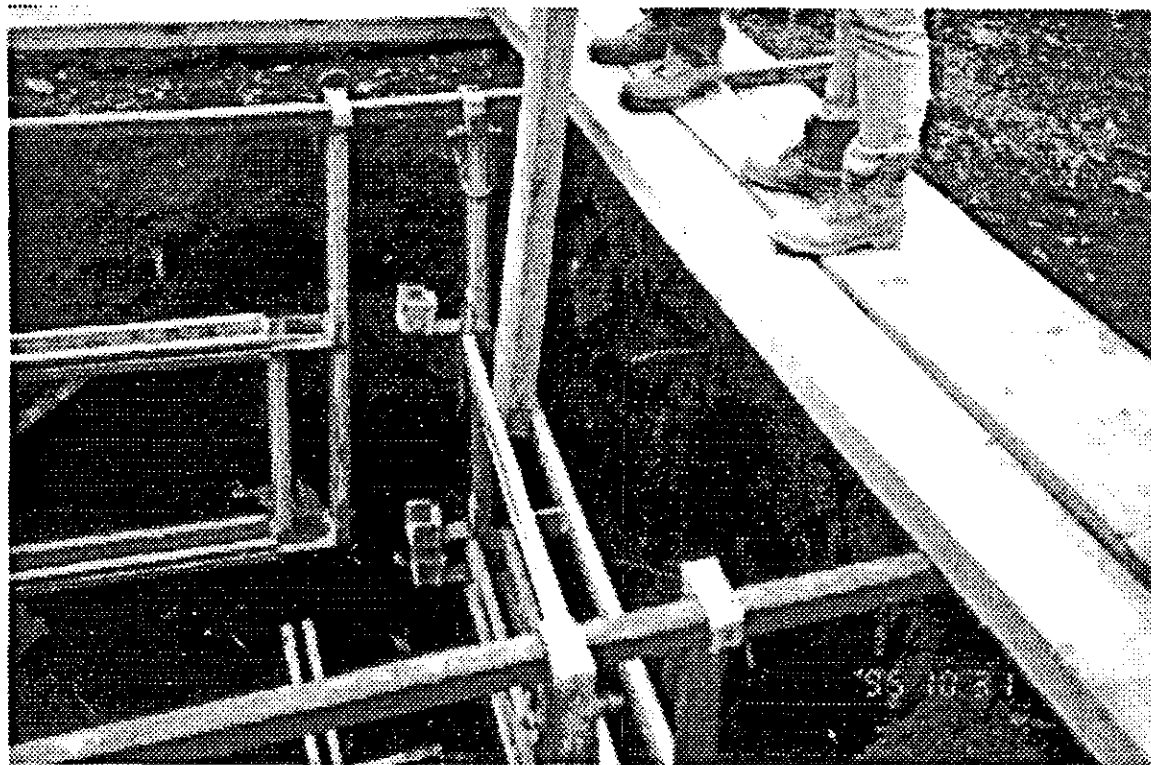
Pose des madriers verticaux du haut de l'excavation.
